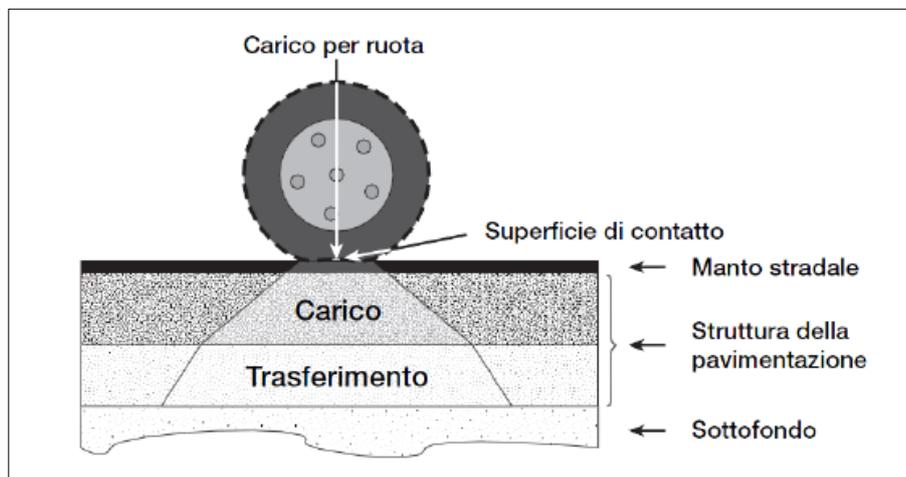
Trasferimento del carico tramite la struttura della pavimentazione stradale
